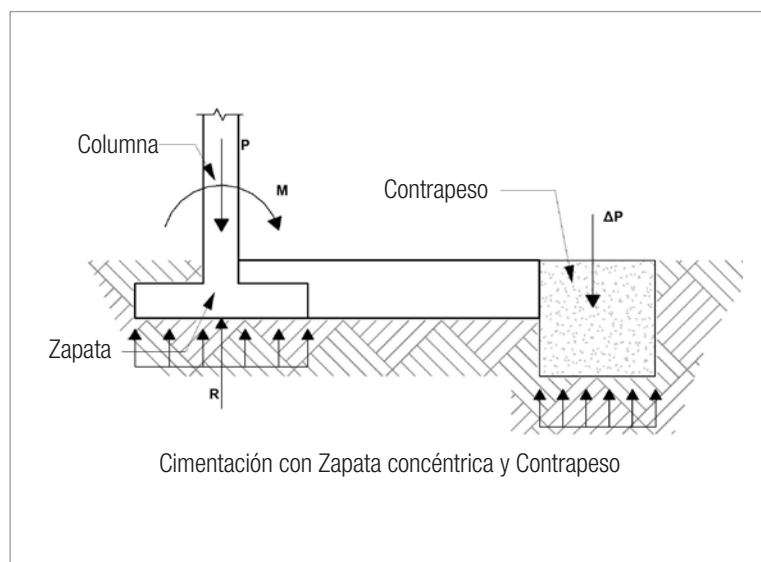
Cimentación con zapata concéntrica y contrapeso.
